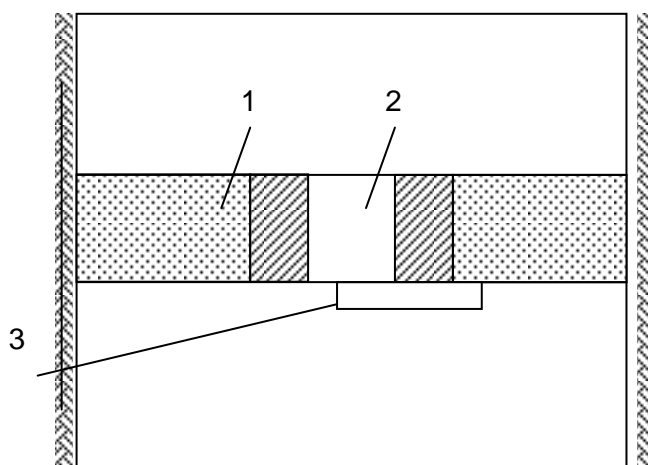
Схема устройства вентиляционного окна в выработке
